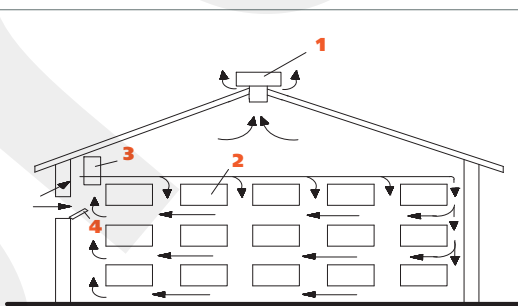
Общеобменная система вентиляции контейнерного хранилища с подачей приточного воздуха над штабелем:
